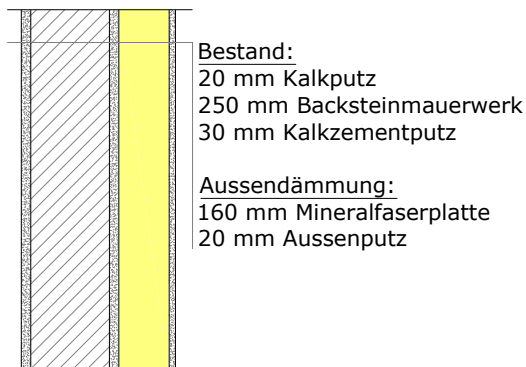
Skizze der Variante der Aussenwärmedämmung mit Angaben zum Wandaufbau
